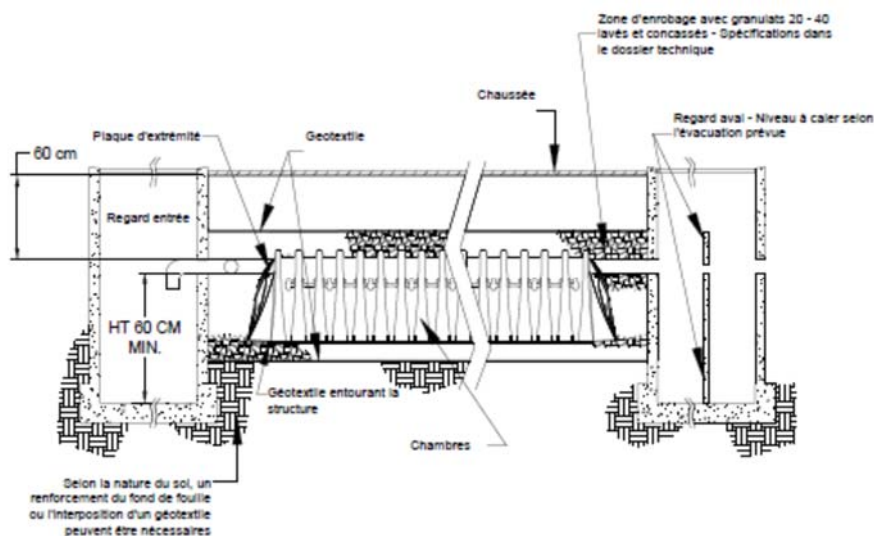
Détails d'admission et d'évacuation en coupe - Exemple des chambres STORMTECH SC740 ou SC310.
